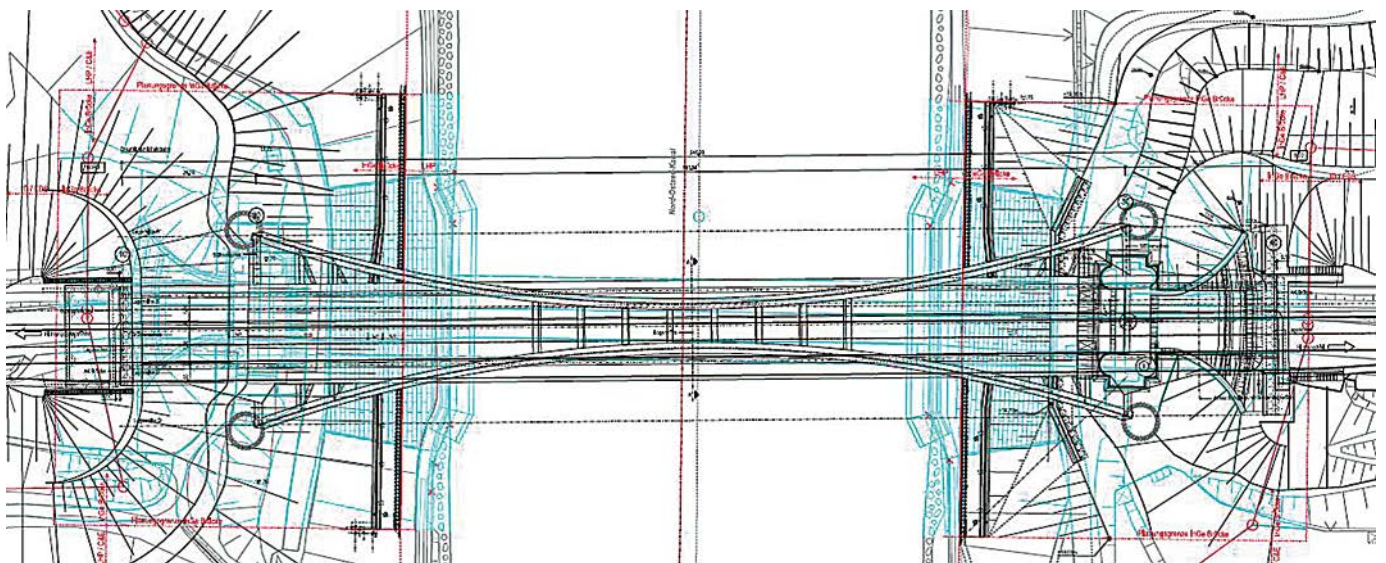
Draufsicht Brückenbau; Bestand blau hinterlegt (Planung WKC-Anwika)
